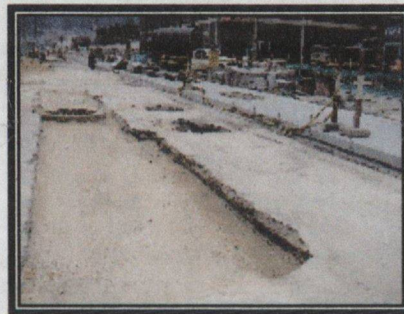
, Proceso constructivo Calle 13, 24-04-03
